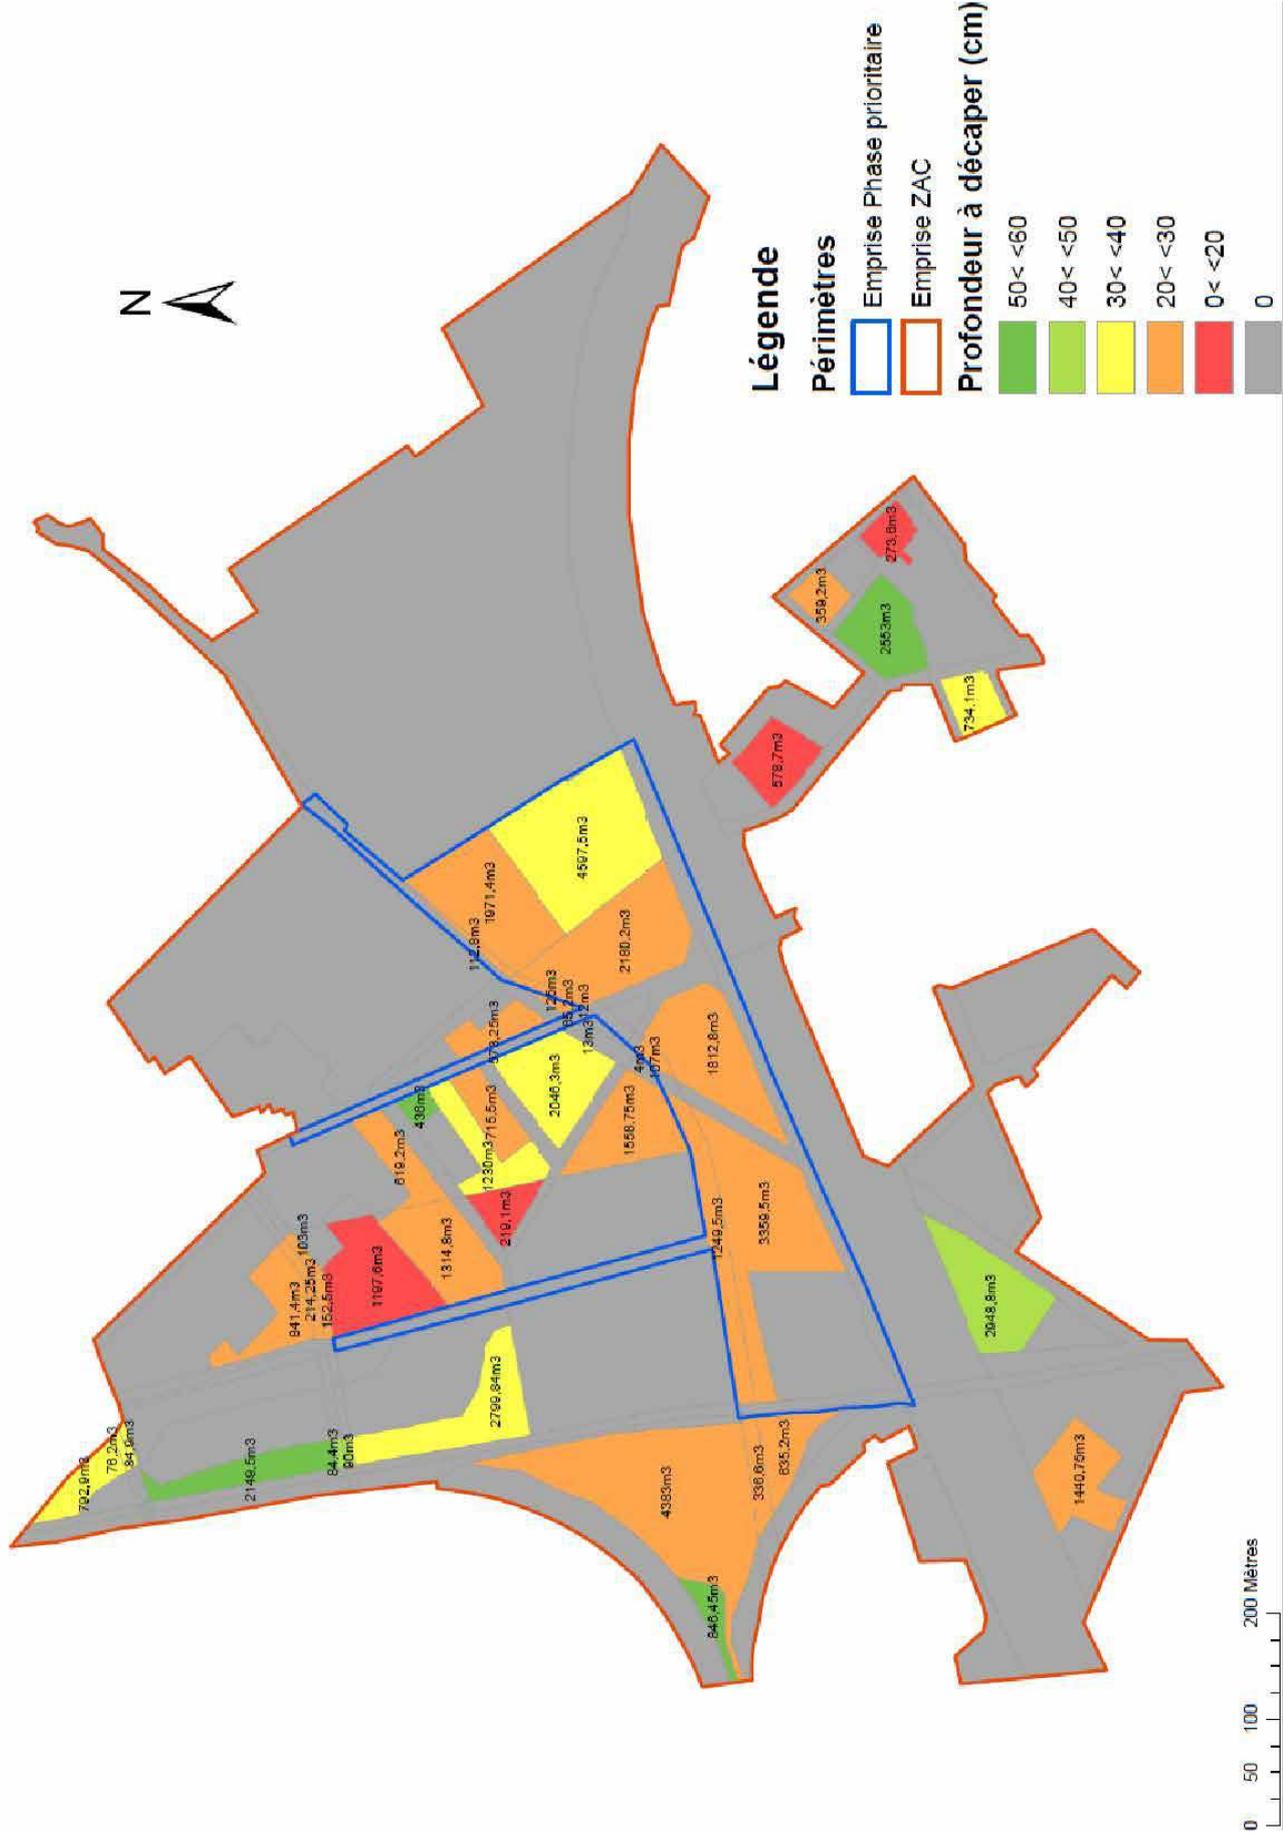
Exemple de plan de décapage (source : © Sol Paysage)
